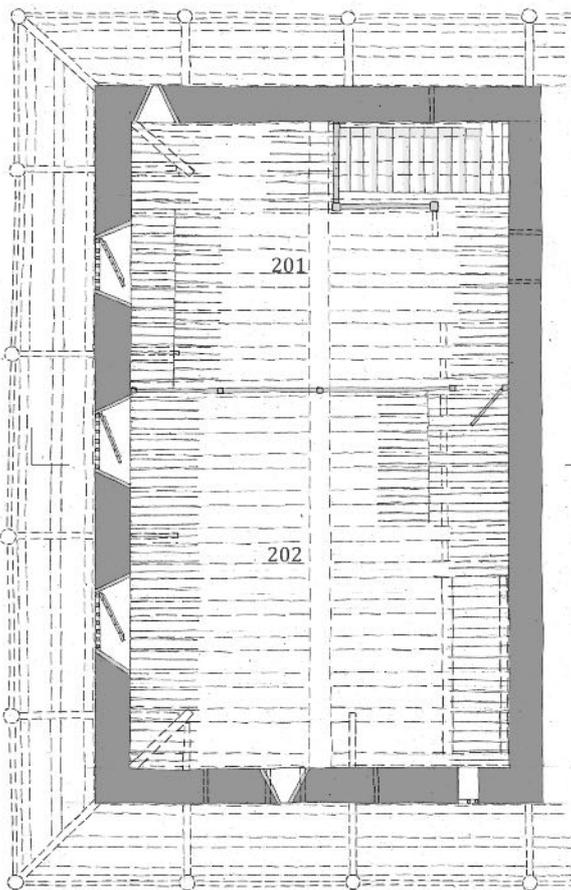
Grundriss Wachturm (2. OG), M 1:100
